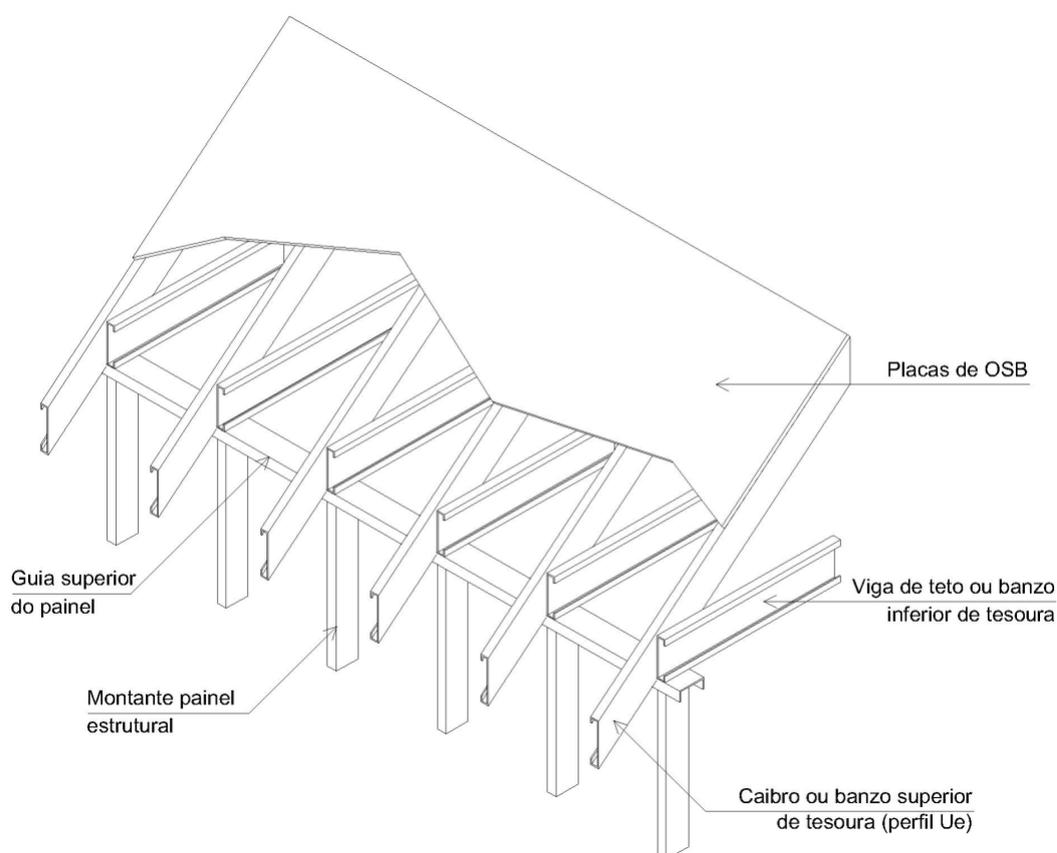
Caibros e vigas alinhados com montantes de painel estrutural.
